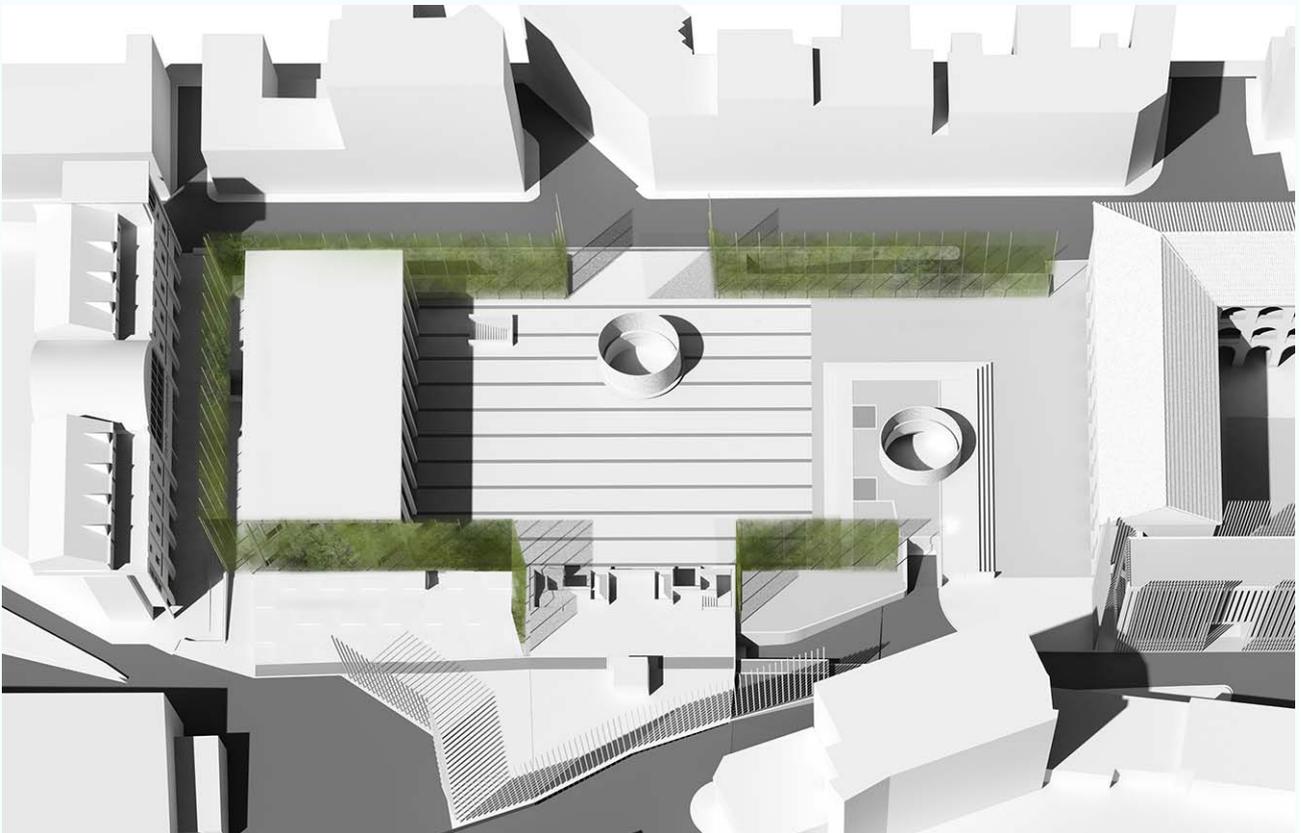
Planivolumetrico con individuazione delle quinte verdi
